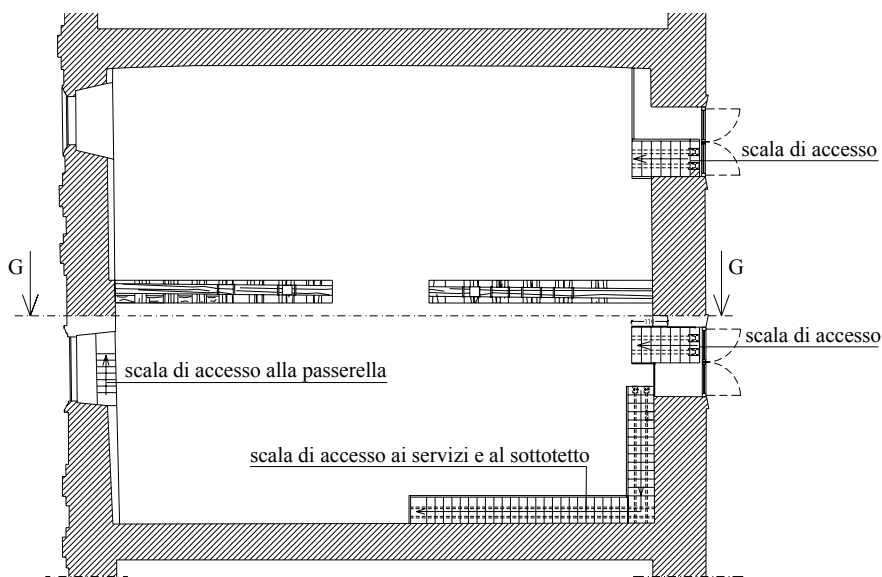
Scale di accesso: a) Posizione in pianta.
